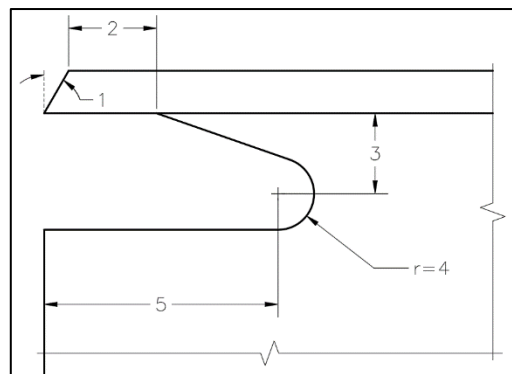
Esquema de parámetros geométricos para acceso a soldadura (elaborado por el autor)
